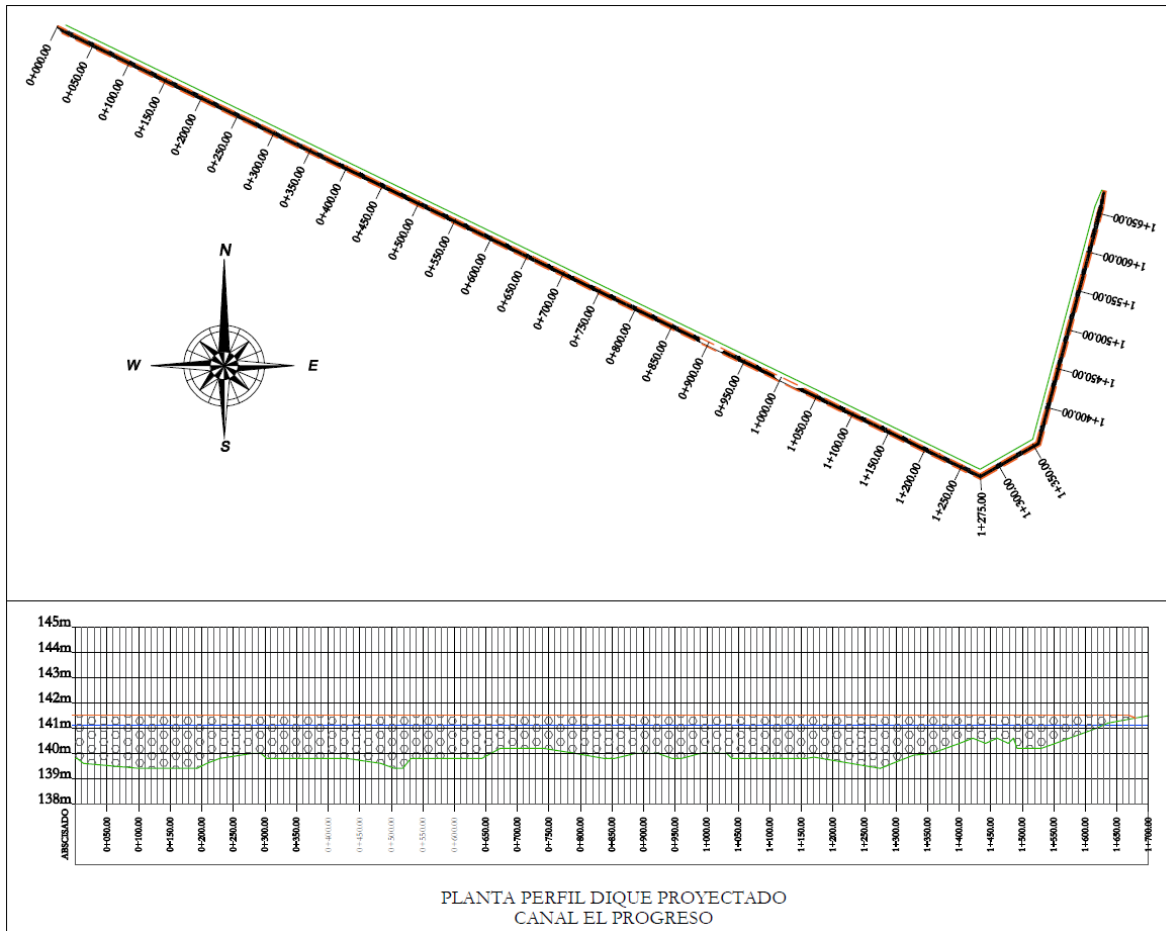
Planta de Ubicación de la Estructura de Contención
